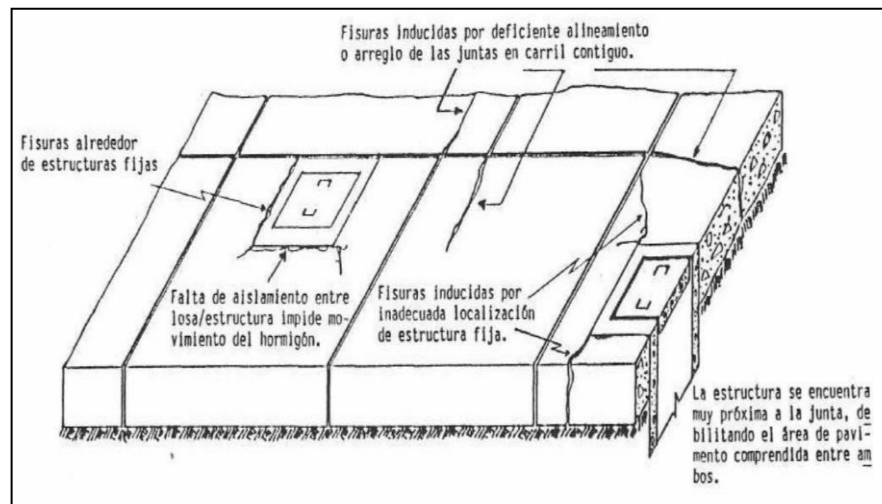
Falla por fisura Inducida de Pavimento Rígido
